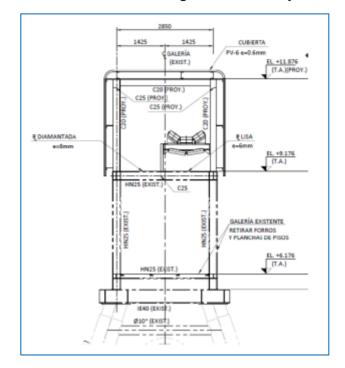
Elevación transversal de la galería existente y estructura de cierre
